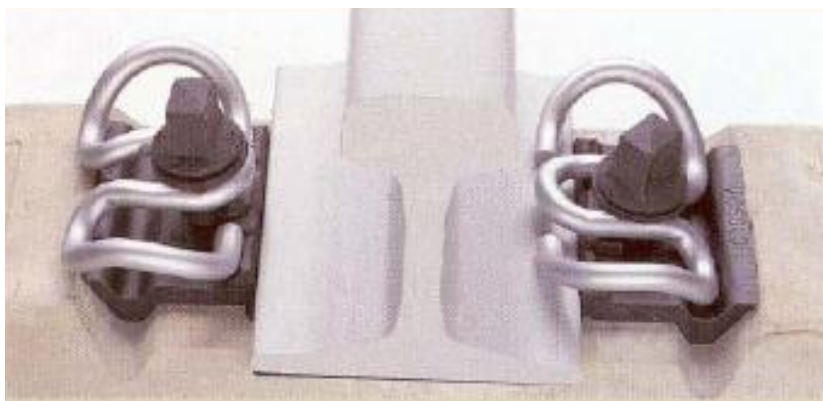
Fixações do tipo SKL para betão (UPV, 2008)
